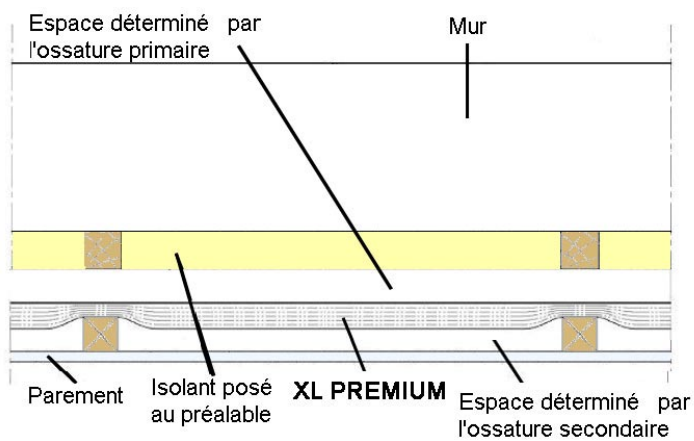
Schéma de pose sur mur en maçonnerie courante ou en béton.
